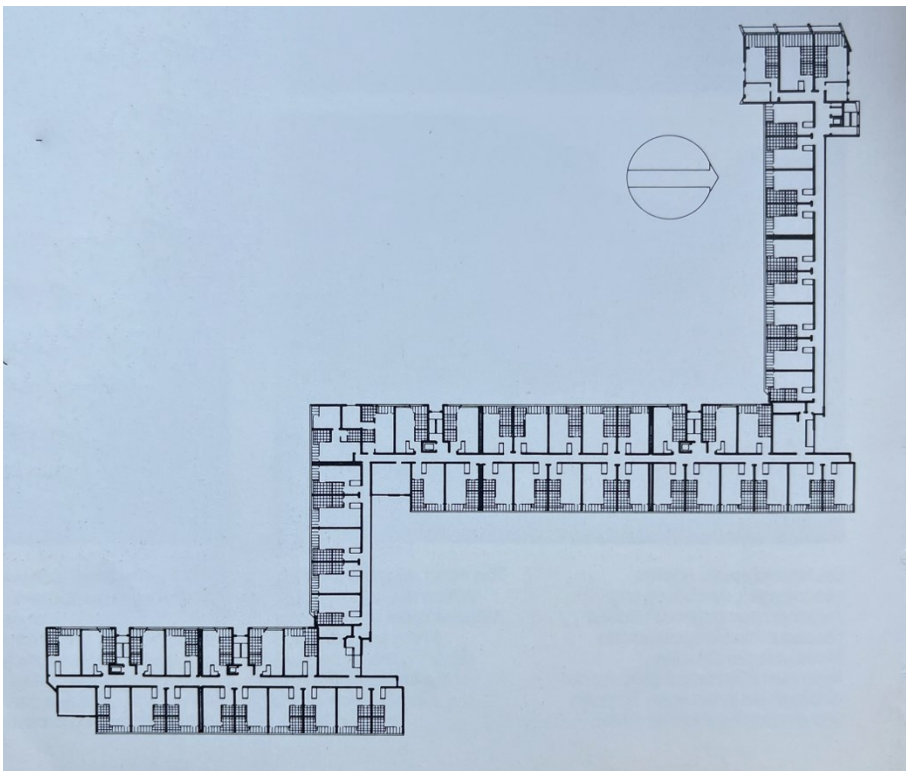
Johannes Uhl, Altenwohnheim Spandauer Damm 42-44, Mollwitzstraße, Grundriss, 1977, Berlin.
